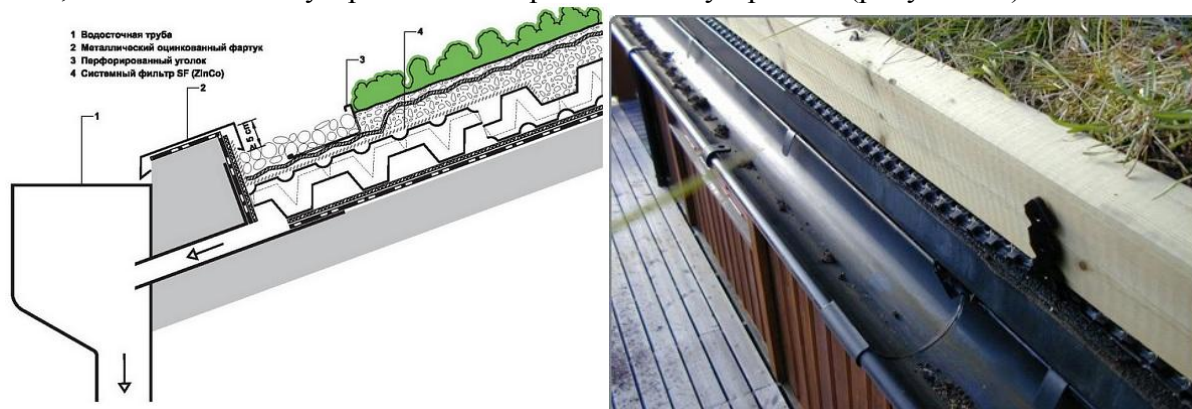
Конструкция наклонной зеленой кровли – сдерживающие устройства
